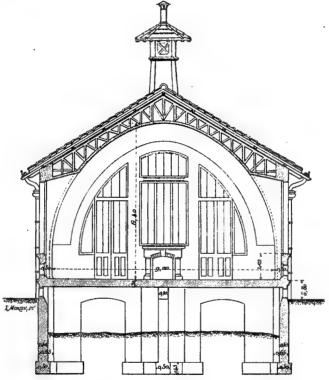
L'hôpital Boucicaut; coupe d'une salle de malades.
